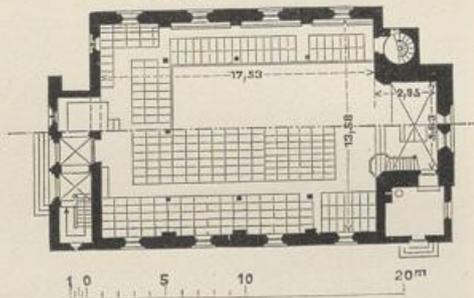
Grundriß in Emporenhöhe und zu ebener Erde.
